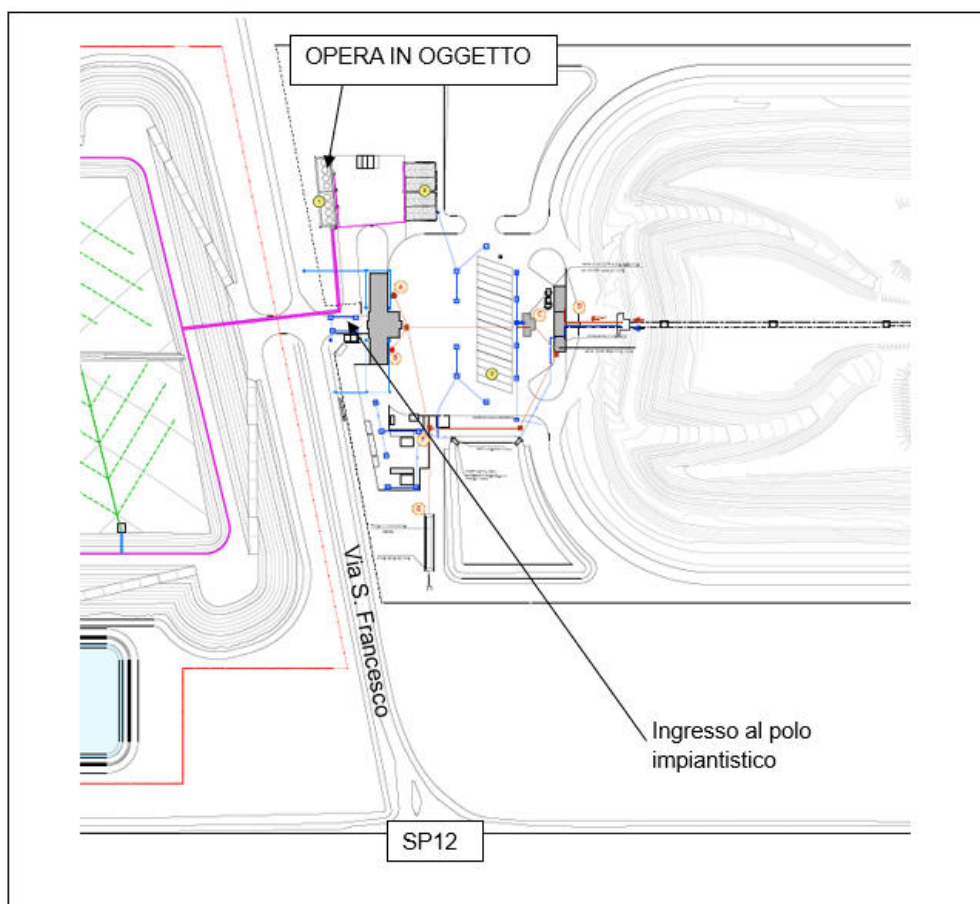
Stralcio planimetrico con indicazione dell'ubicazione dell'opera
